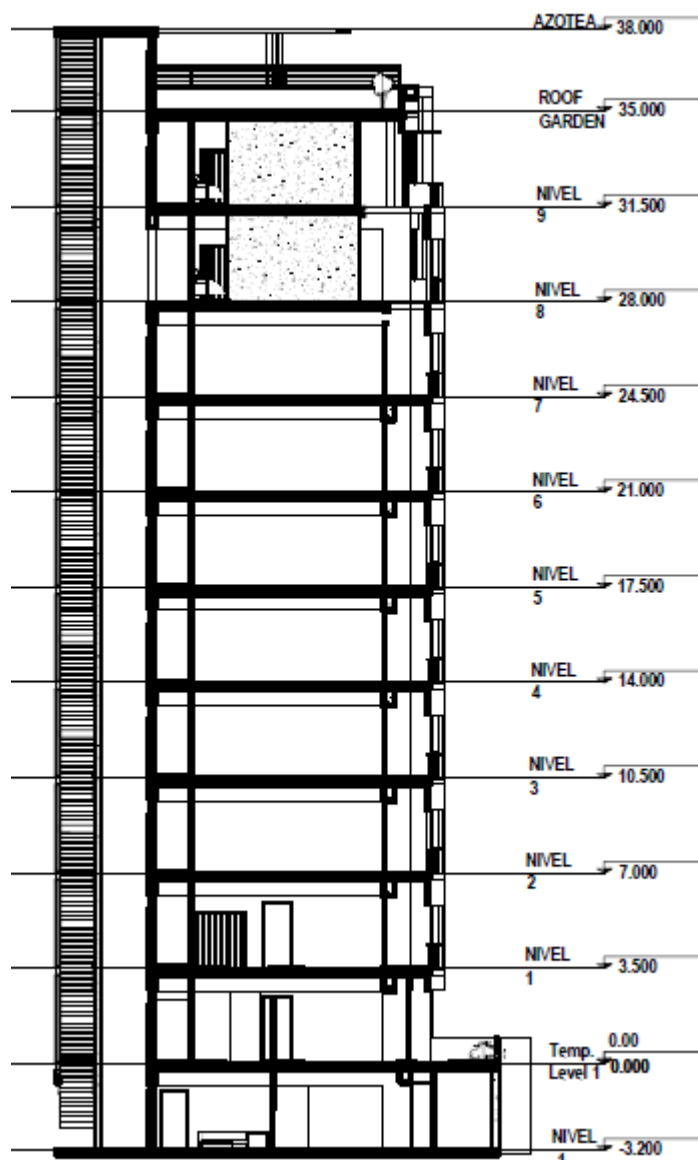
18. Alzado lateral de un edificio tipo B, en donde se observan los niveles a construir.
